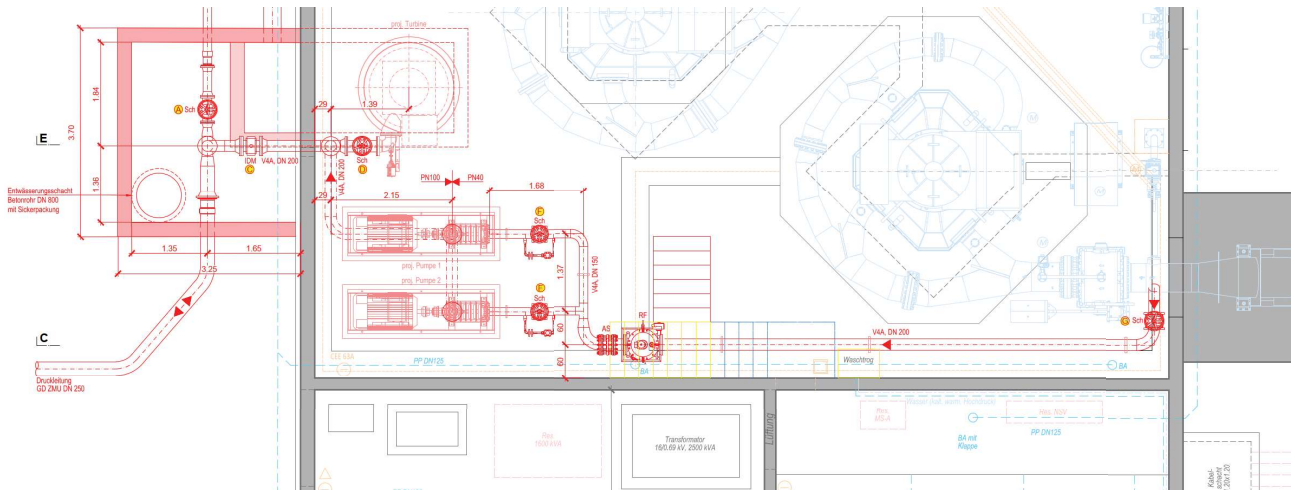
Ausschnitt Grundriss Maschinenhaus mit Anbau für die Anlage des Pumpspeicherkraftwerks
